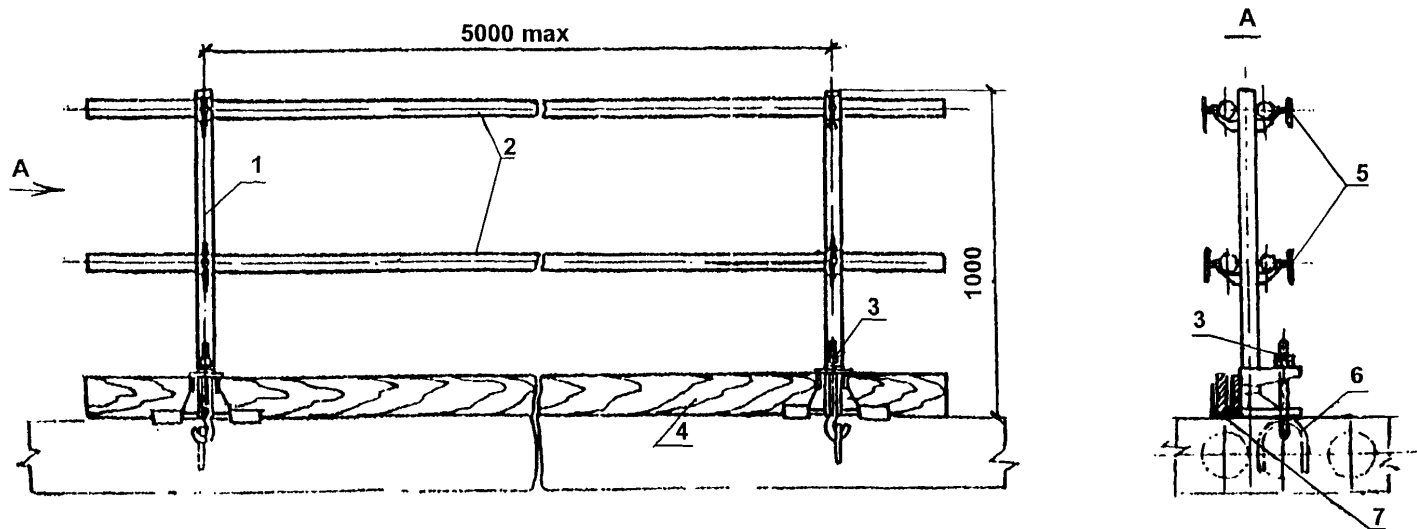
Временное ограждение на перекрытии (трубчатое) с креплением за монтажную петлю:
